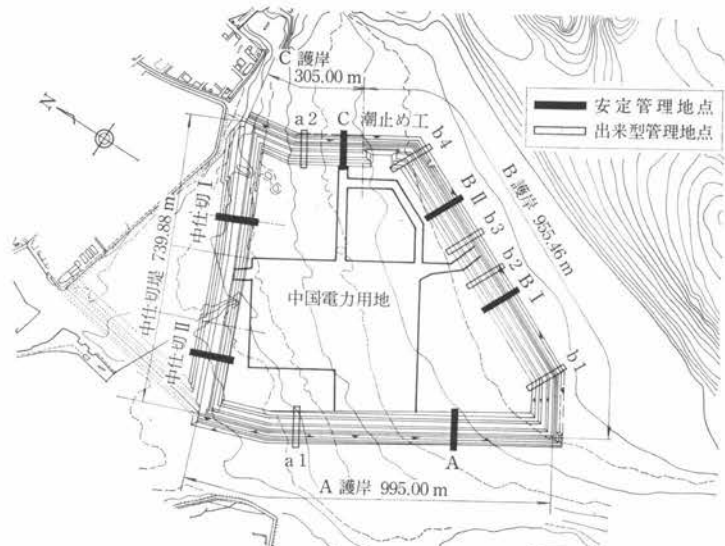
柳井(発)埋立地平面図および護岸計測位置平面図
